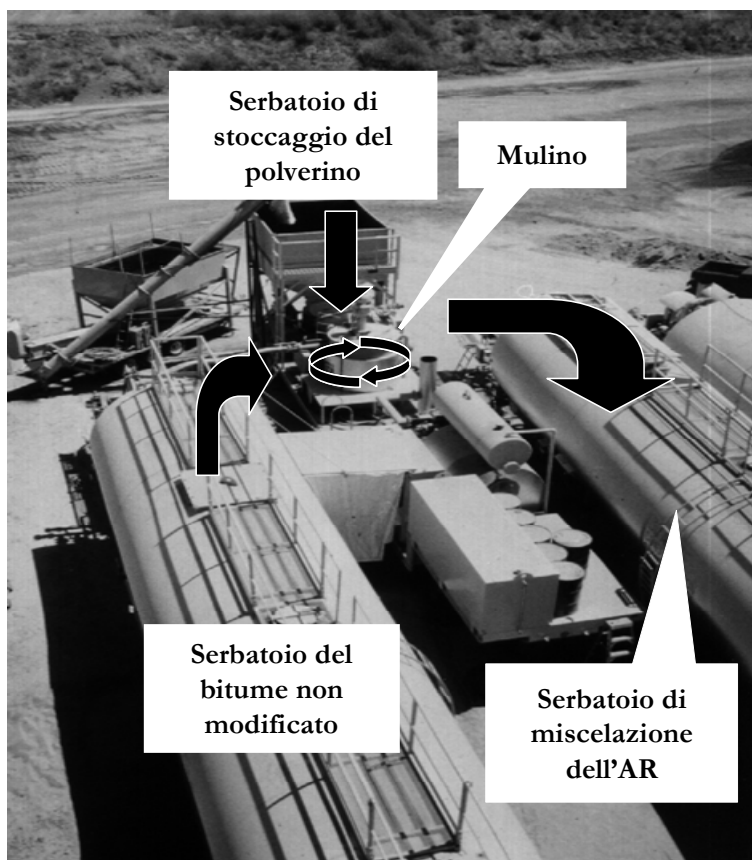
Esempio di impianto di produzione di Asphalt Rubber del tipo *continuous drum dryer plant
